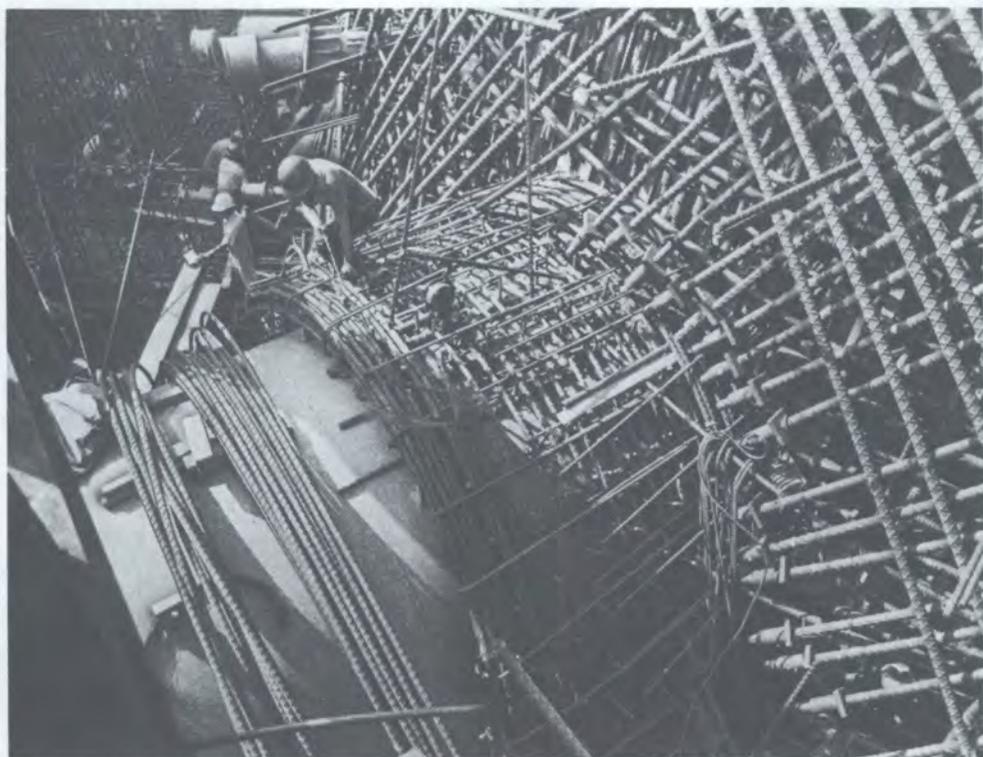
, 4, 5. Установка люка (диаметром 12 футов) для демонтажа оборудования в решетку из армирующих стержней.
